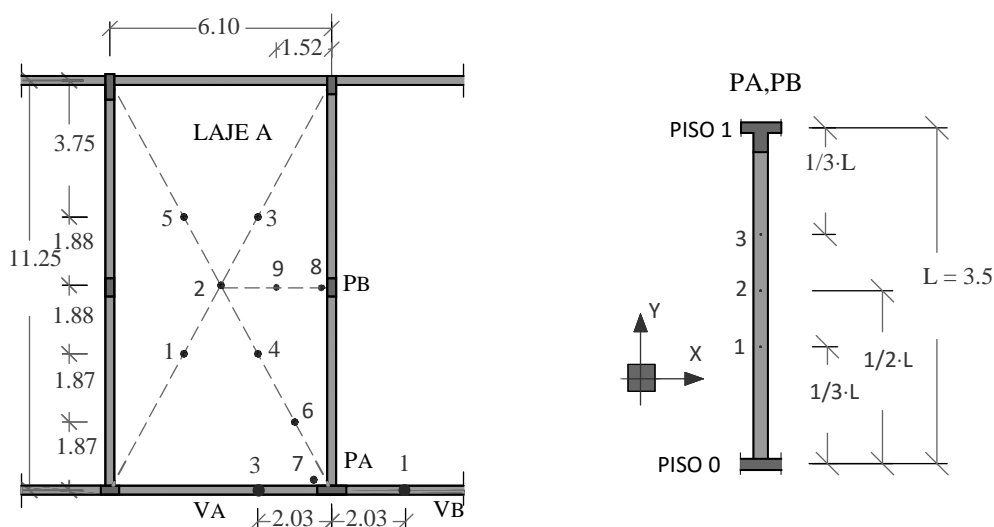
Elementos estruturais do edifício da escola ensaiados.
